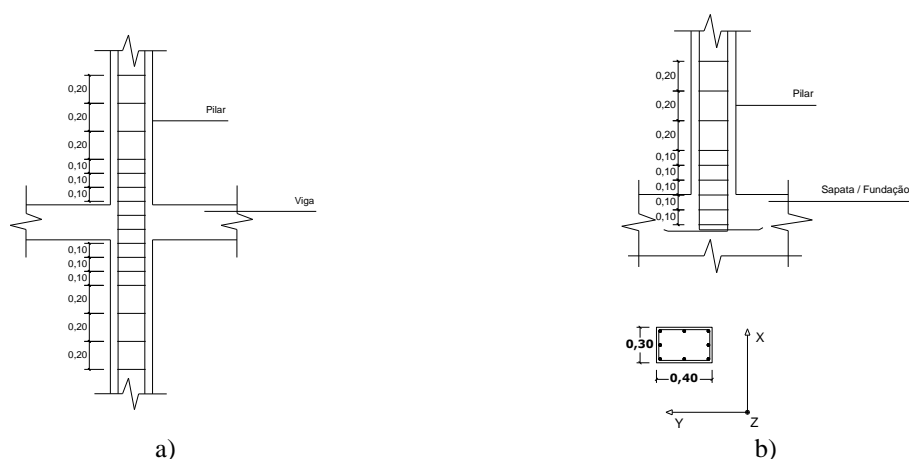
Pormenor das armaduras do pilar: a) - Zona das vigas; b) - Zona da fundação.
